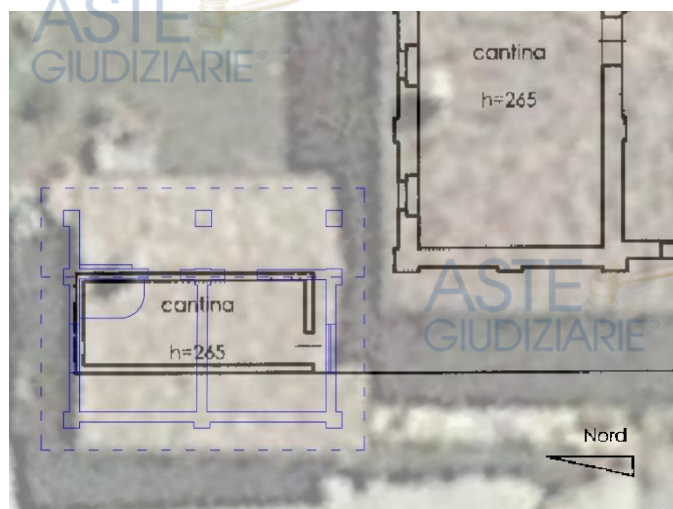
Sovrapposizione tra foto aerea e planimetria catastale con individuato graficamente il nuovo locale deposito
